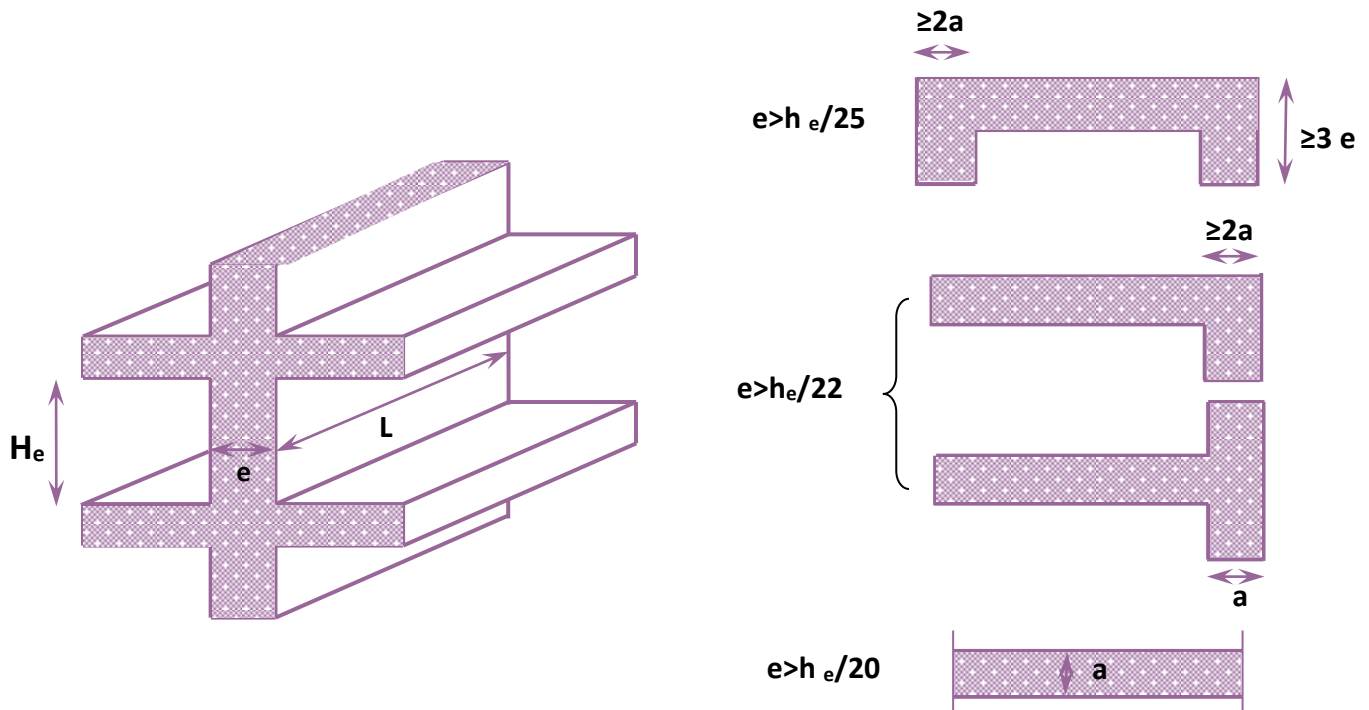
Coupe en élévation et de voiles en plan pour différents cas
